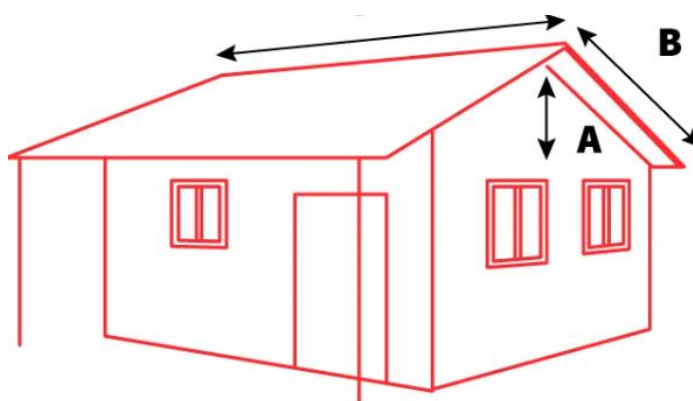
Área Horizontal; Fuente (Andrea Barragan, 2023)
